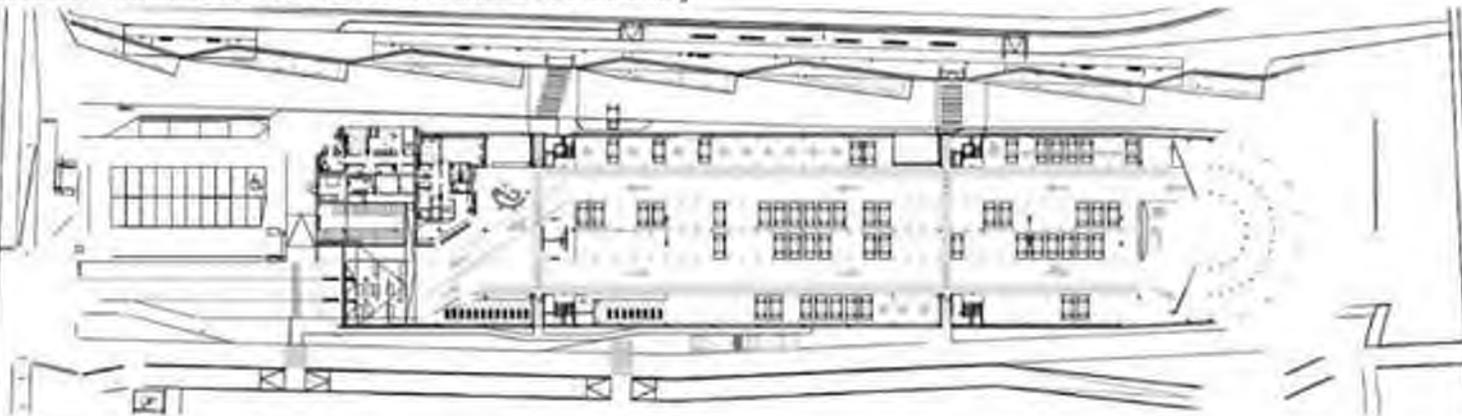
PARKING AND INTERMODAL STATION, Archdaily.
